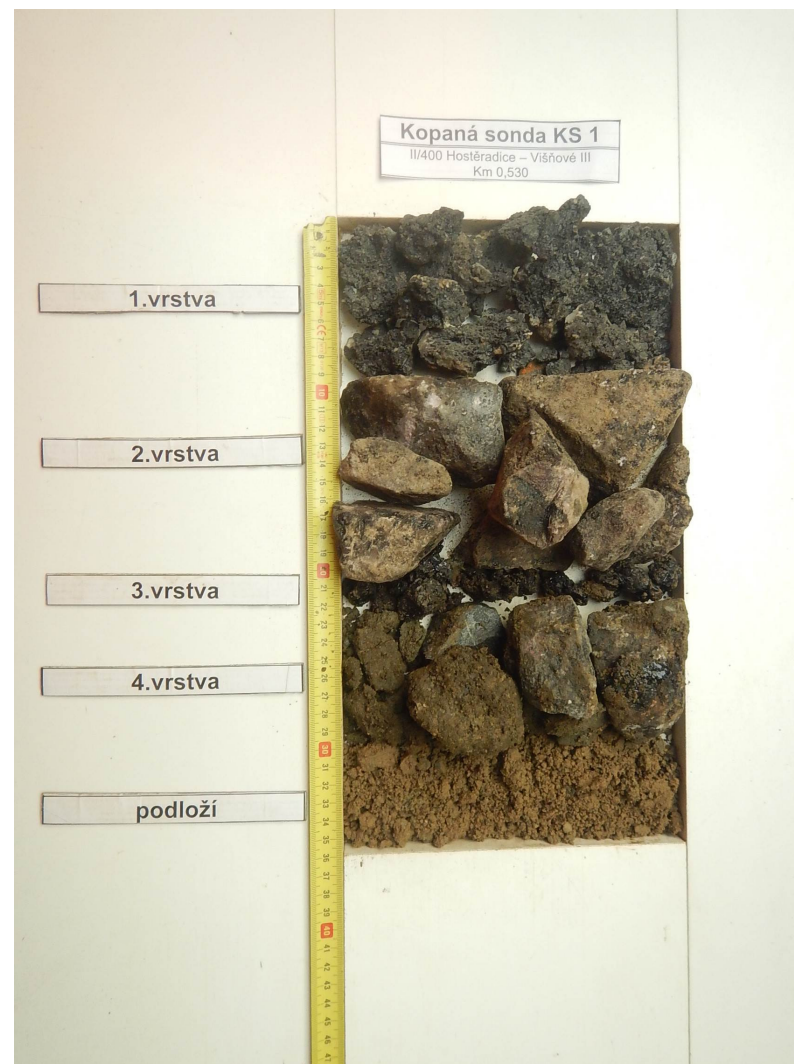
a č. 2 - Kopaná sonda KS 1
